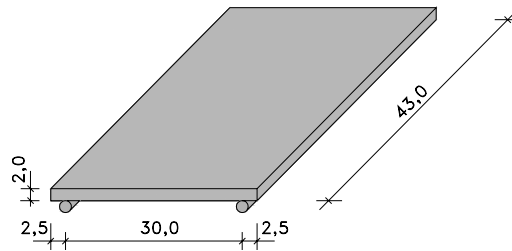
Dimensões da peça utilizada no ensaio de flexão (Un. cm)
